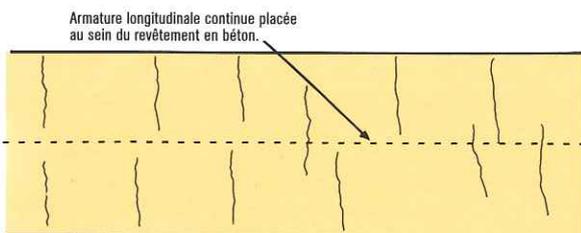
Schéma du comportement des revêtements en béton exécutés sans joints mais armés longitudinalement par une armature continue. Fissuration contrôlée et fine.
